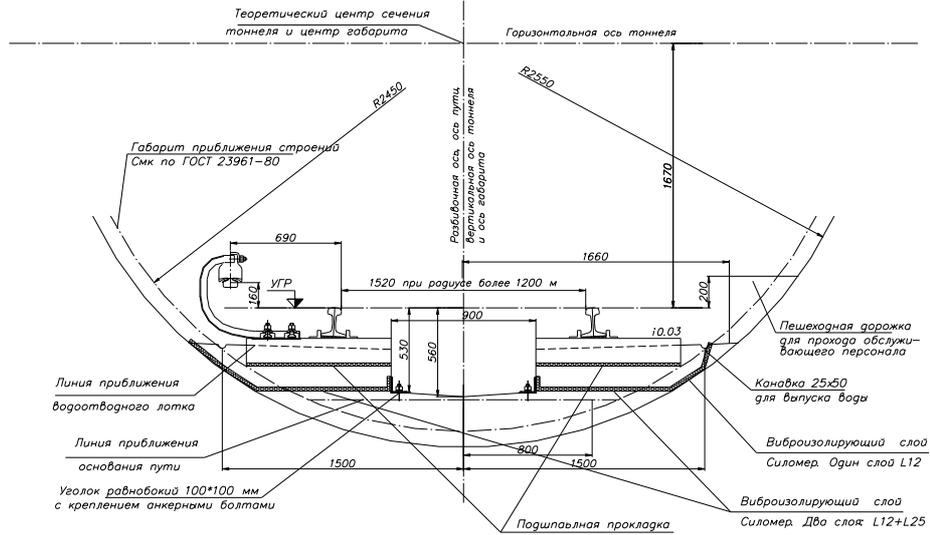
Конструкция пути с железобетонными шпалами – коротышами
